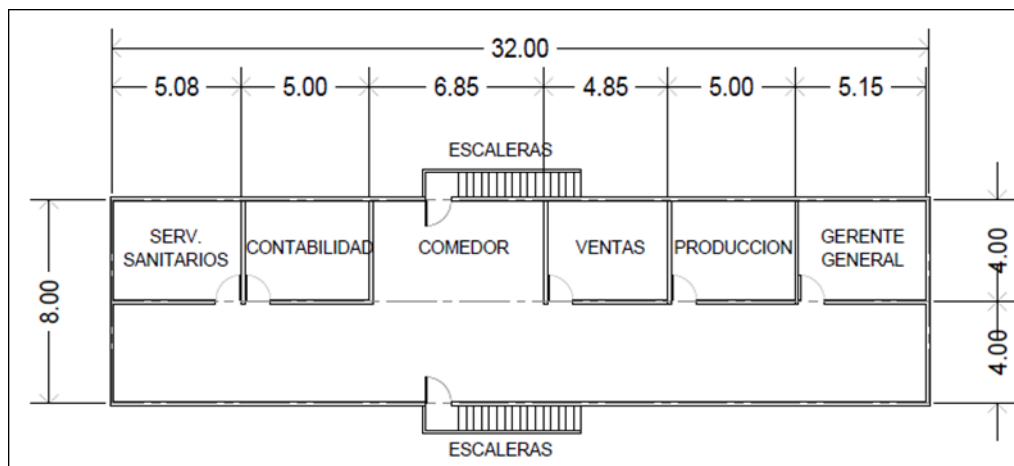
Planta alta arquitectónica del área de administrativa
